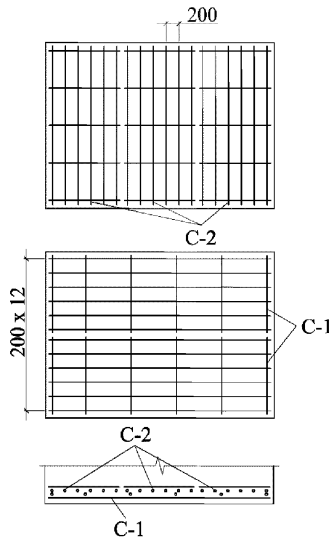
Расположение сварных сеток при армировании фундамента узкими сетками
